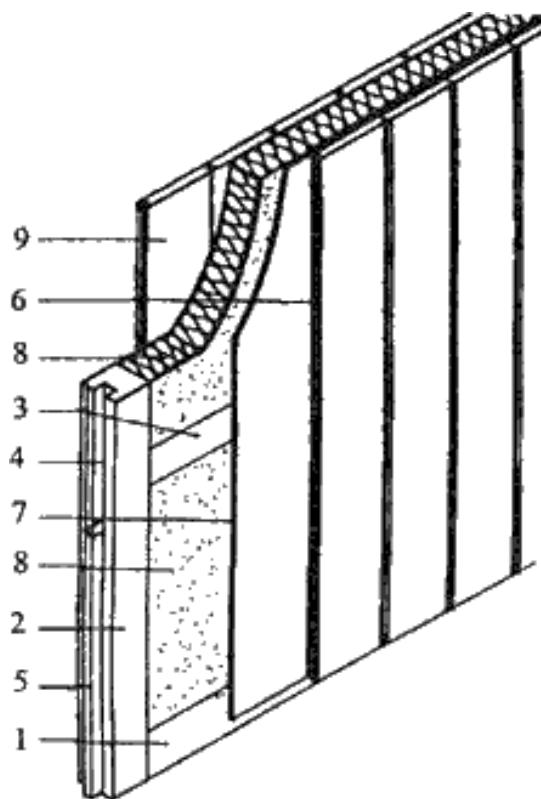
Многослойная конструкция щитового стенового элемента: 1 — лежень рамочного каркаса; 2 — стойка рамы; 3 — реберная балка рамы (рамный шпангоут, ридерс); 4 — установочный паз; 5 — установочная рейка; 6 — внутренняя деревянная обшивка; 7 — паронепроницаемый слой; 8 — теплоизоляция; 9 — наружная обшивка.
